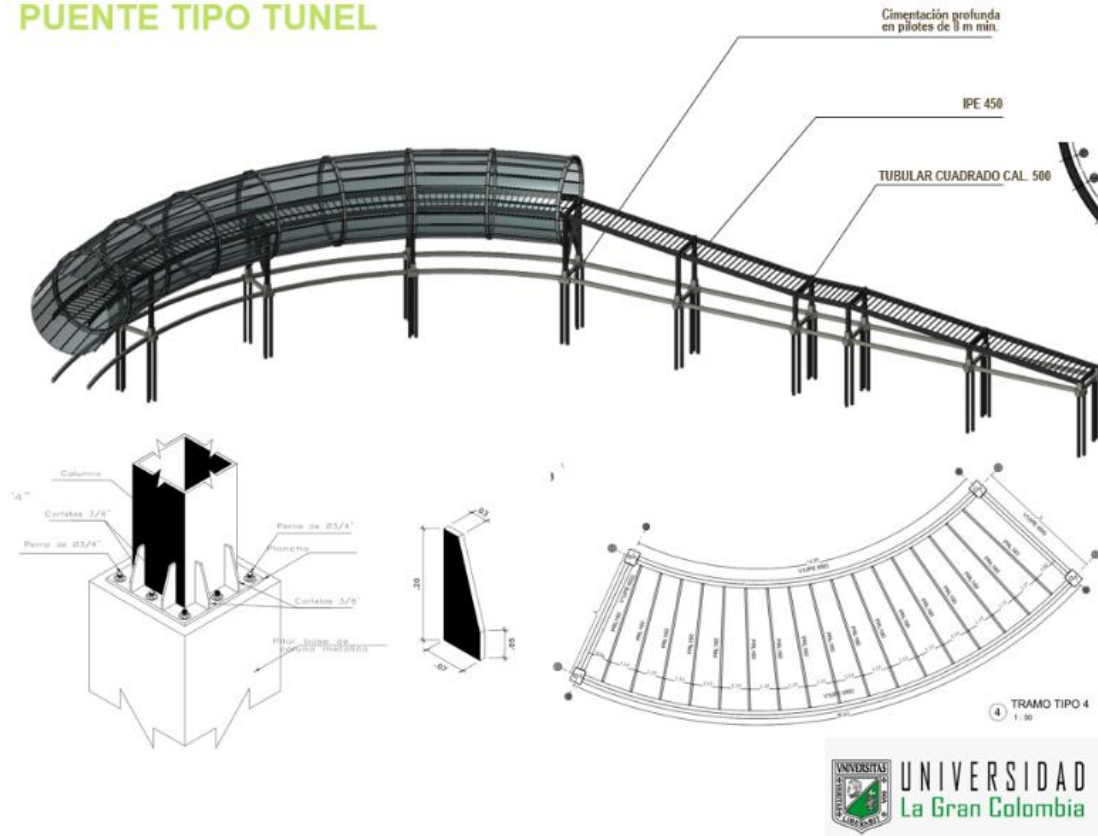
Elementos estructurales Pasarela de Avistamiento. Elaboración propia.
